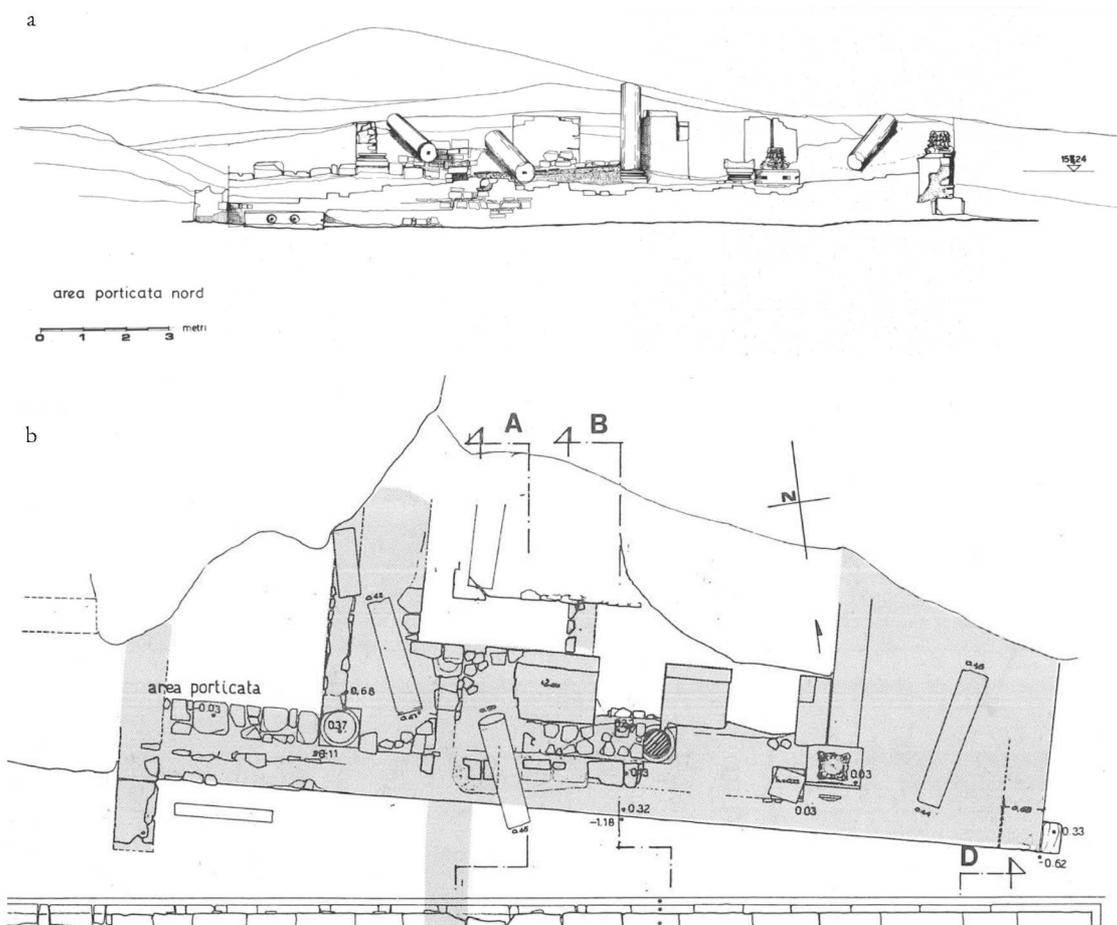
Prospetto meridionale e pianta dell'edificio nel rilievo degli anni Ottanta (da RICCIARDI 1986/87; a) © Archivi SAIA, NIG 4208/55; b) © Archivi SAIA, NIG 4208/57).
